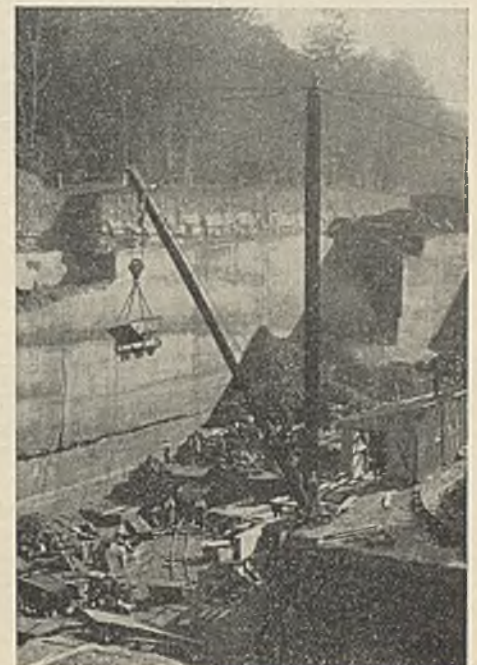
Einsäuliger, seilversteifter Mastenkran.
